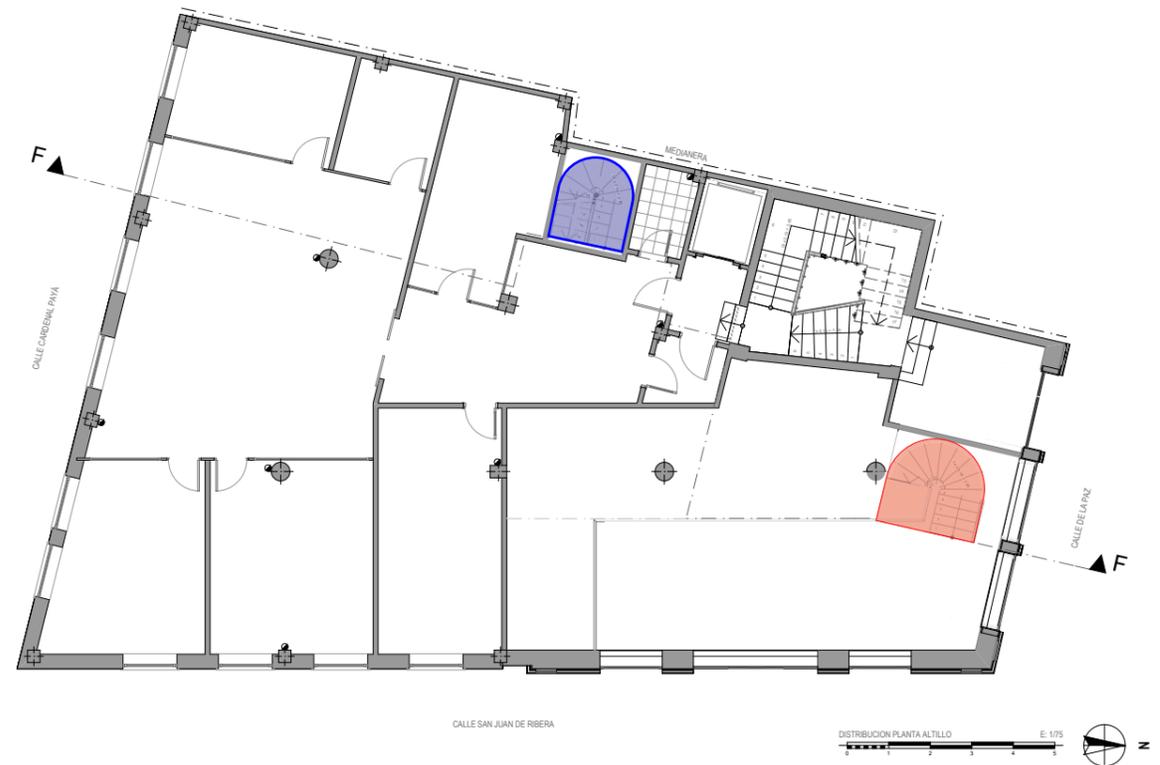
Comunicación vertical privada desde planta sótano hasta planta segunda.
